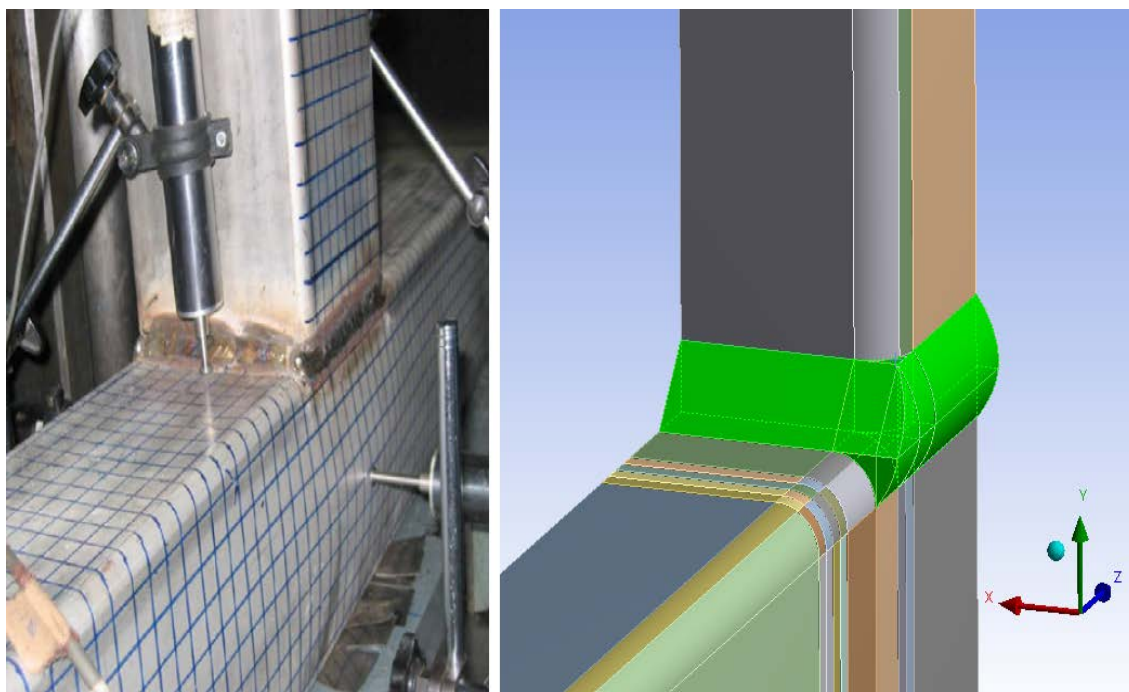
Modelo 3. Soldadura ensayo experimental (izquierda) / nuevo modelo de soldadura (derecha)
